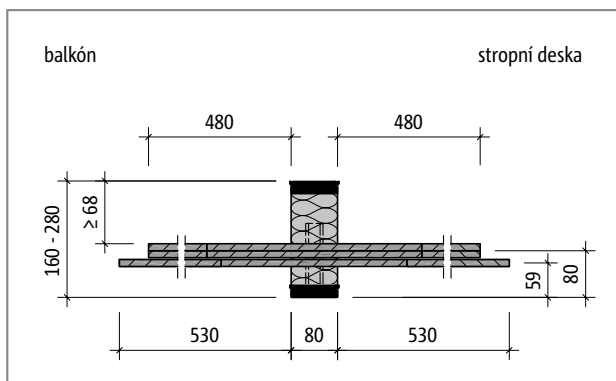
Schöck Isokorb® T typ HP-NN2: Půdorys prvku
